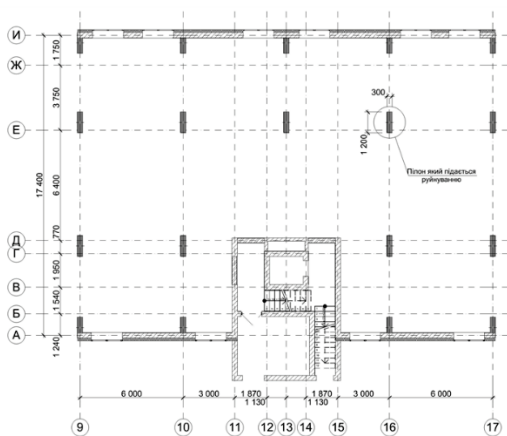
Конструкція каркасу дев'яти поверхової будівлі
